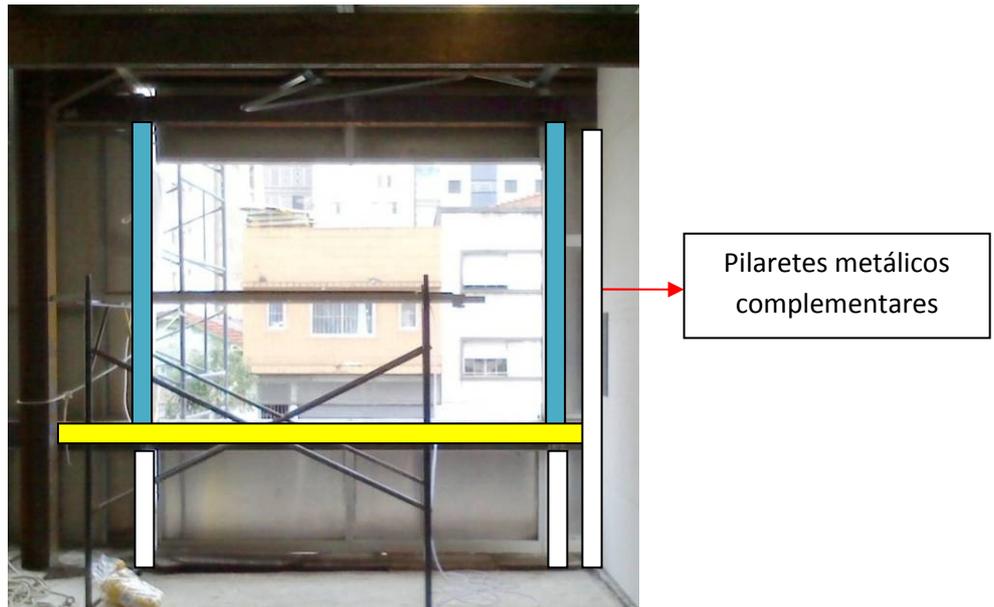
Vista interna do vão onde será instalado o guarda-corpo em vidro com os pilaretes de fixação
